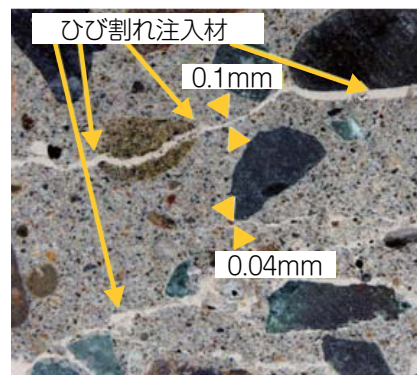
ひび割れ注入材のひび割れ充填状況写真
